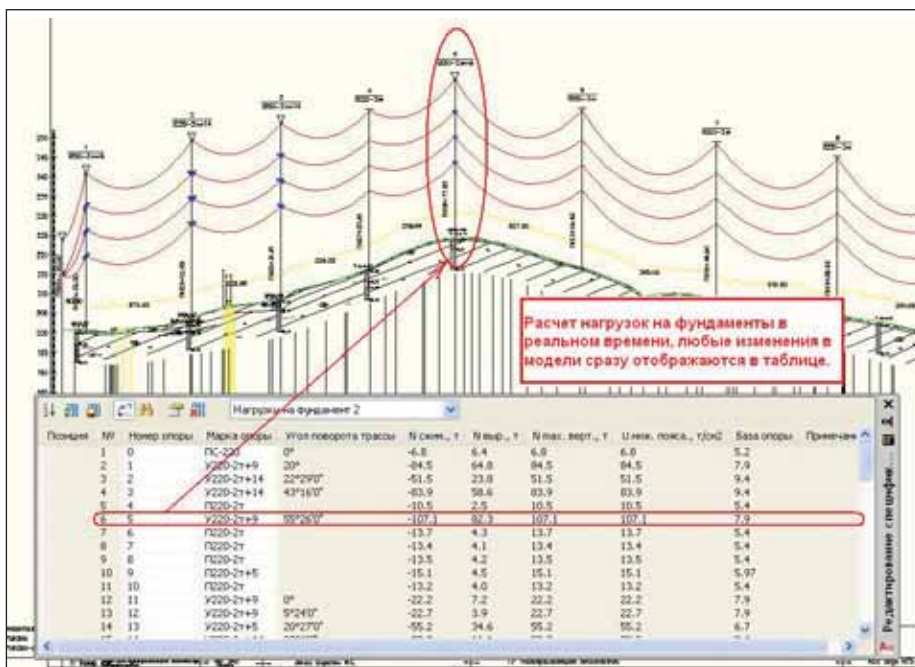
Расчет нагрузок на фундаменты опор в реальном времени
